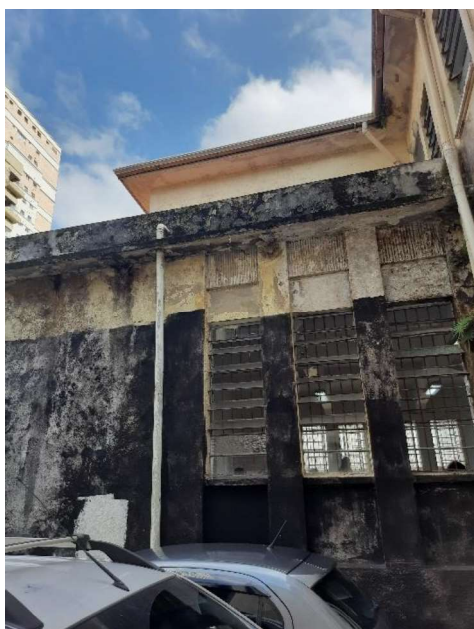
Parede com umidade, deverá ser retirado o revestimento e aplicado argamassa impermeabilizante tipo Viapol plus 1000.
